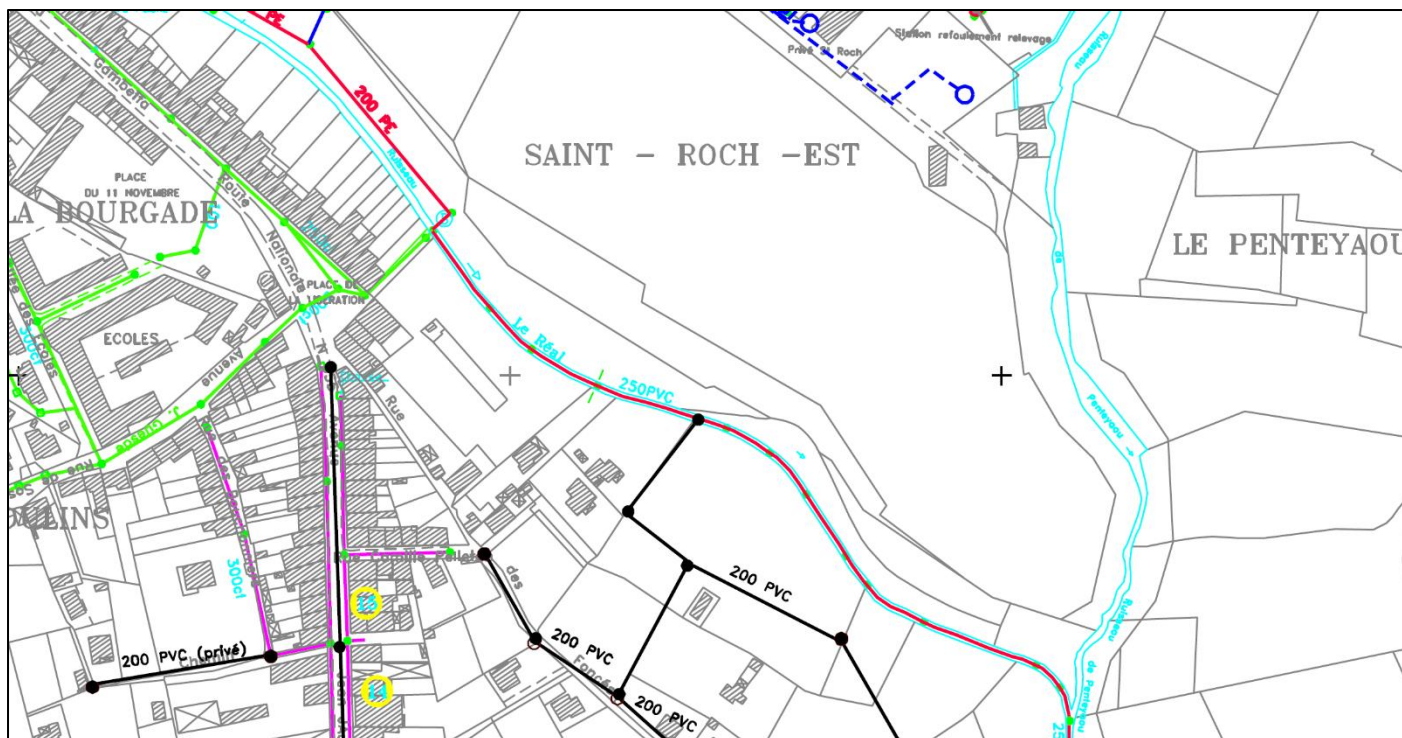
Réseau d'assainissement sur plan annexé au PLU
